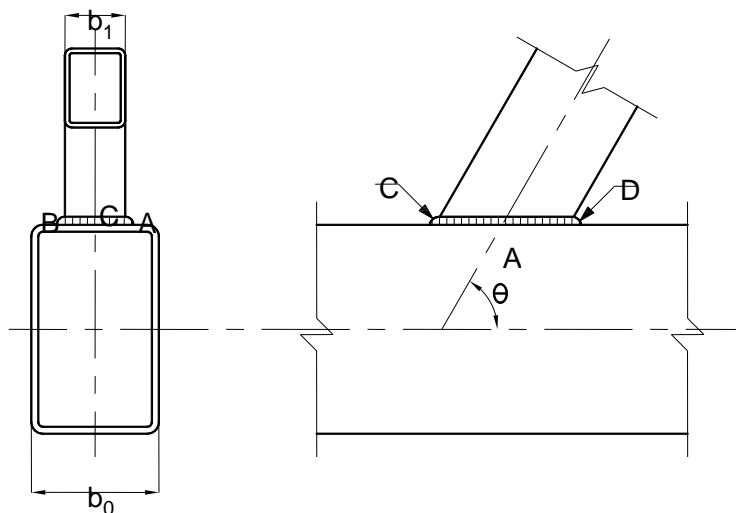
Разделка кромок стыковых сварных швов в узлах конструкций из прямоугольных и квадратных труб
